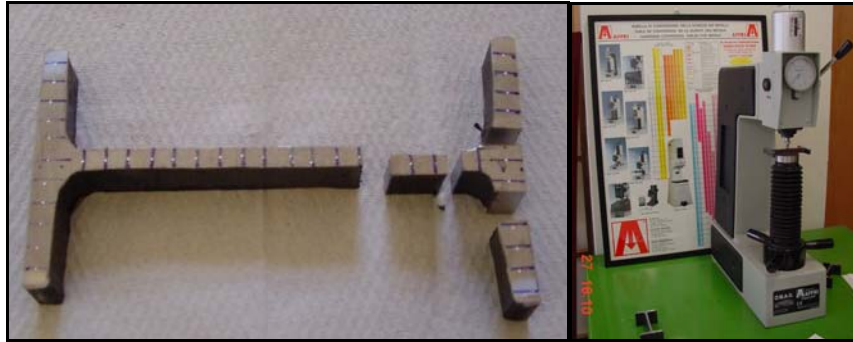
Amostra da secção transversal e procedimento do ensaio.
